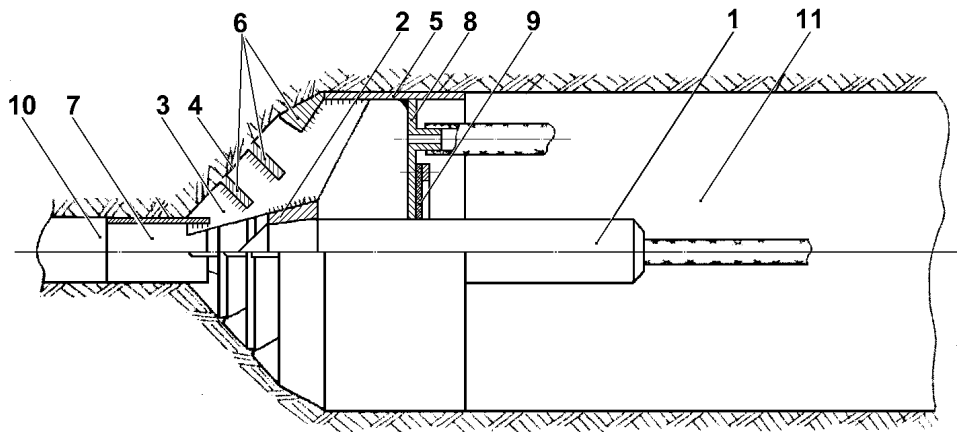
Грунтопроходчик с пневмотранспортированием грунта:
